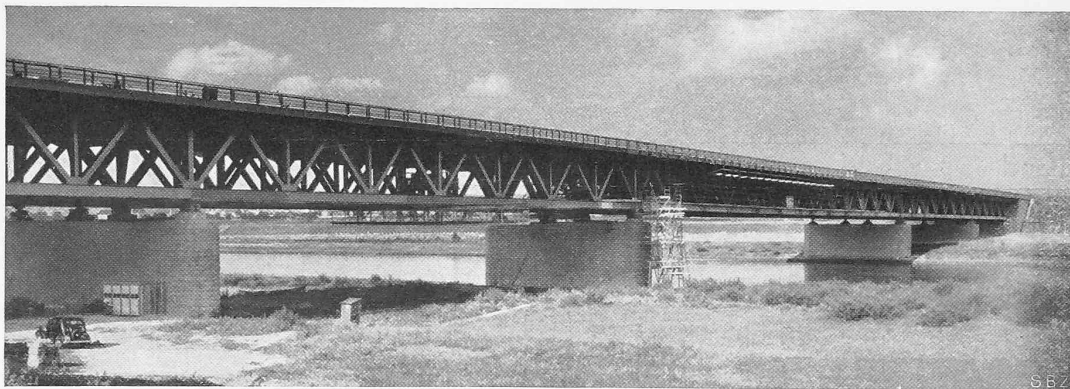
Elbebrücke bei Dresden. Durchlaufende Balken auf steinverkleideten Betonpfeilern; Mittelöffnung 130 m.
